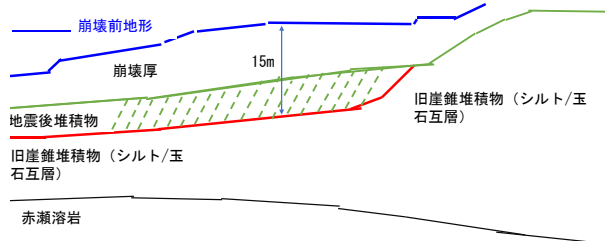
地質ボーリングによる B 横断面図<sup>9)</sup>
